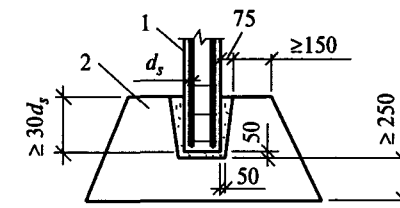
Глубина стакана фундамента: 1 — колонна; 2 — фундамент
